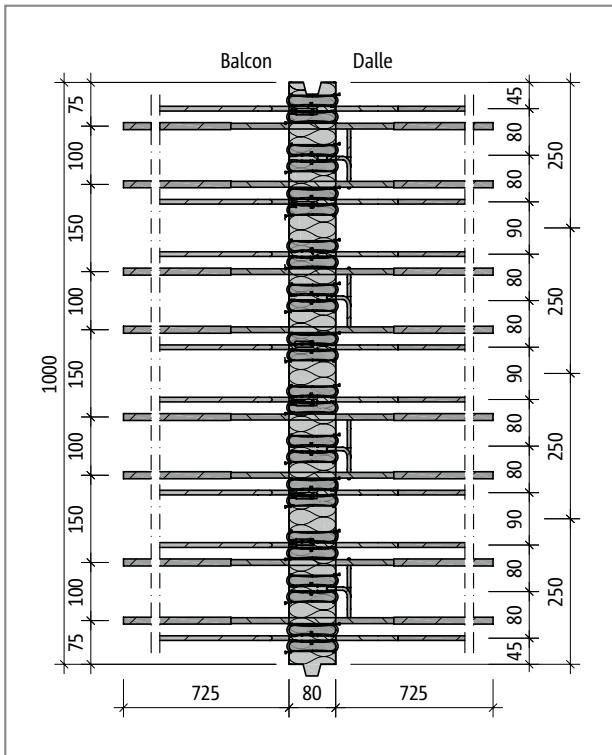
Schöck Isokorb® T Type K-E-M6 : Plan de base du produit
